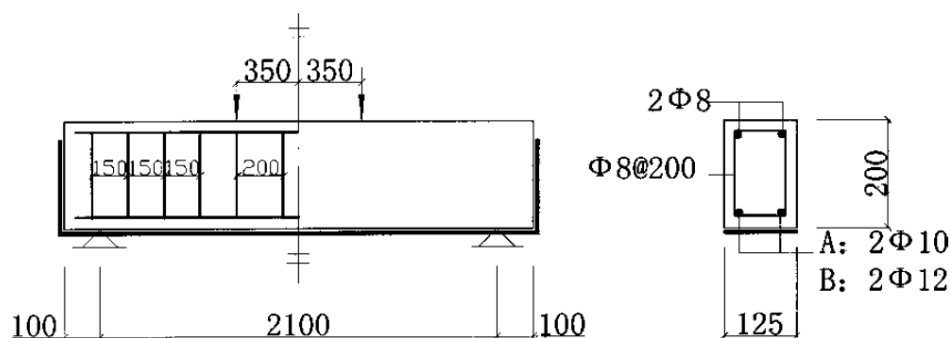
Dimensões em mm e detalhamento das vigas (Xiong et al., 2004)
